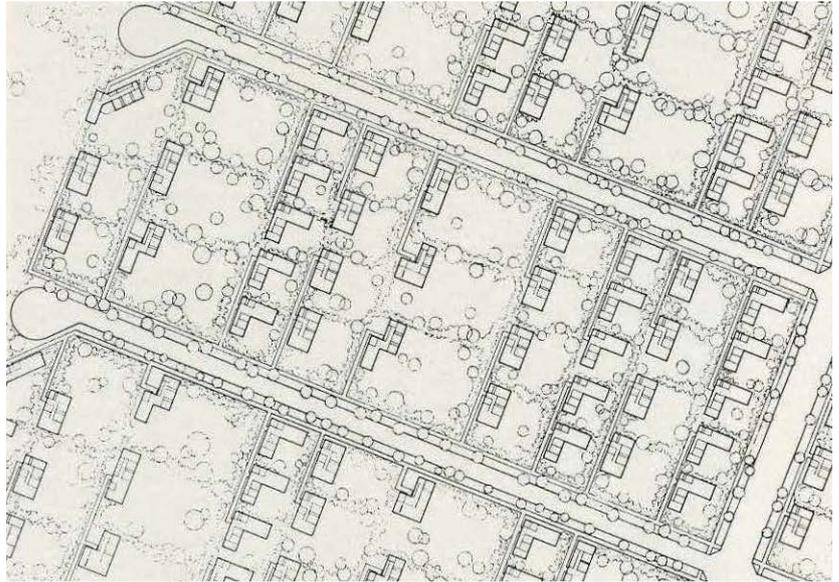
Secondo manualetto, vista prospettica delle unità di vicinato inacasa.
